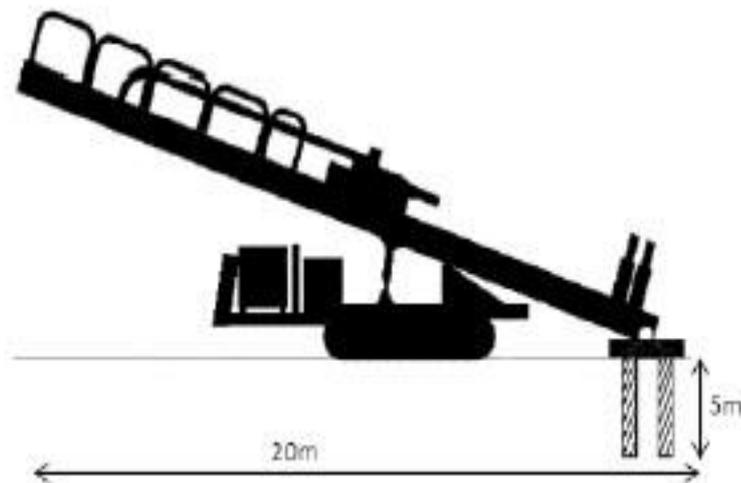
Anclaje de la máquina perforadora Fuente: SEDAPAL.
